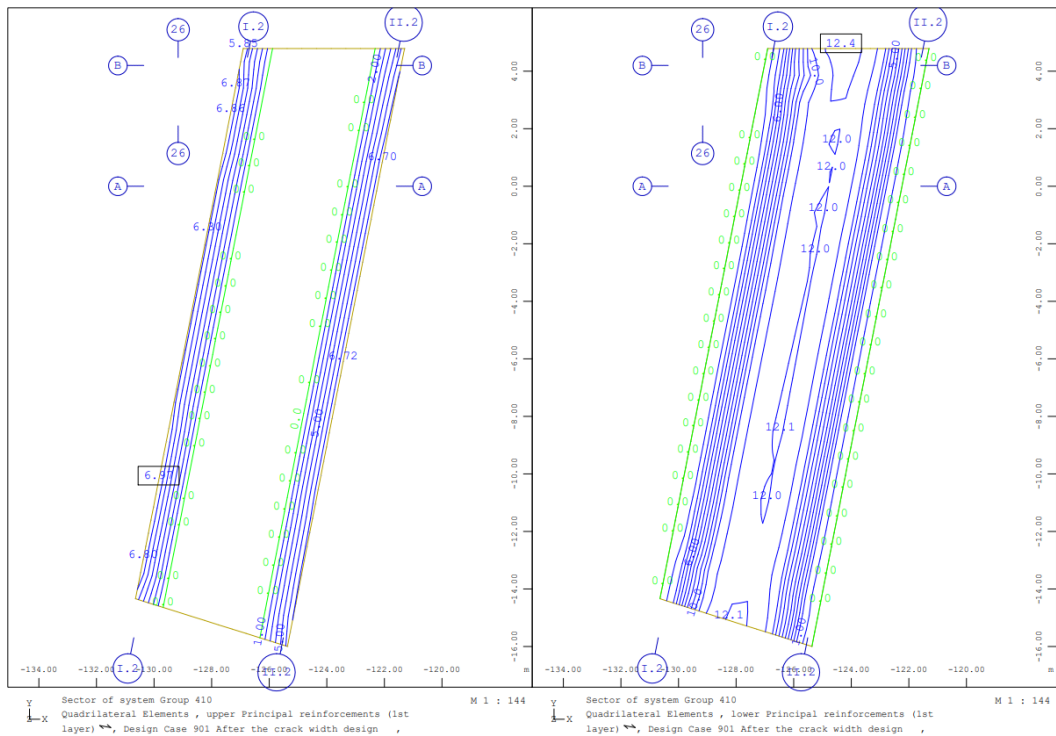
Armadura principal na face inferior (esq.) e superior (dir.) – laje de fundação – túnel - ELS
